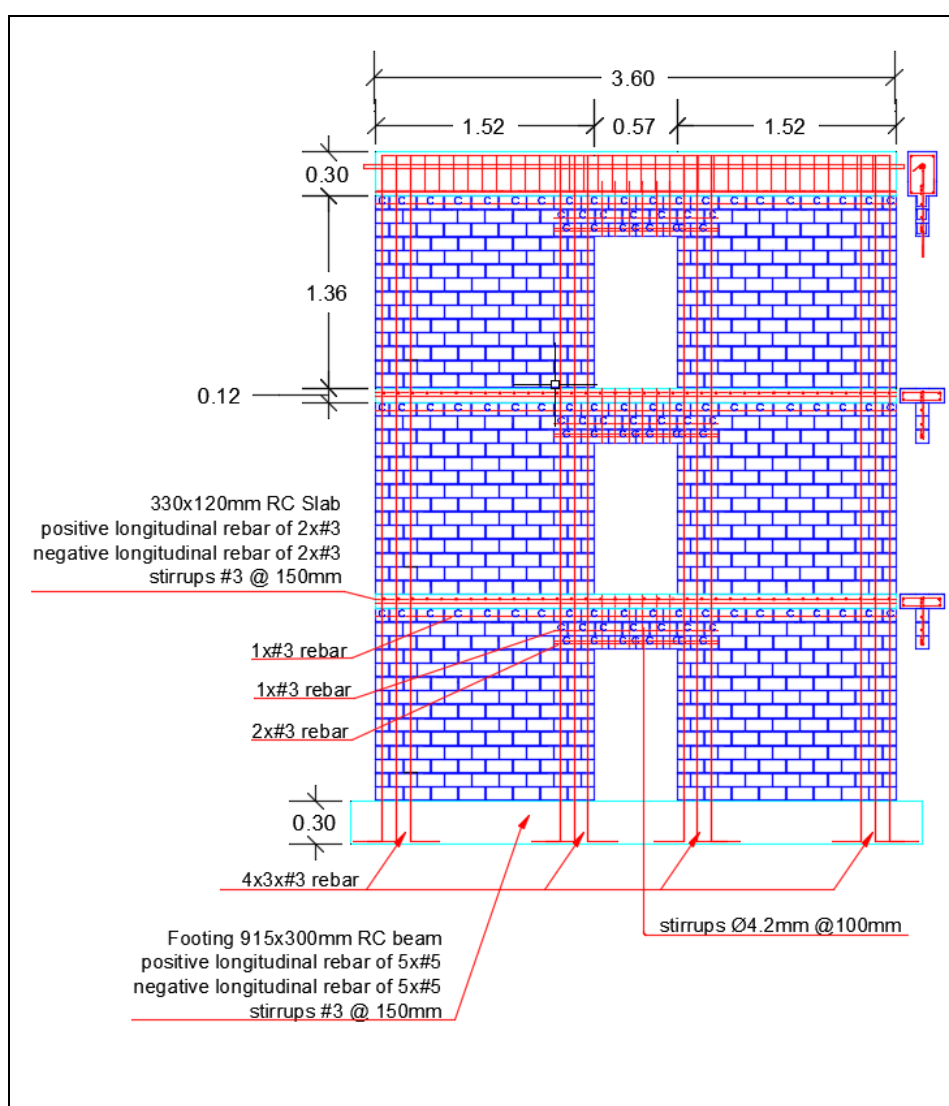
Geometria das paredes acopladas com viga de alvenaria armada e detalhe das armaduras
